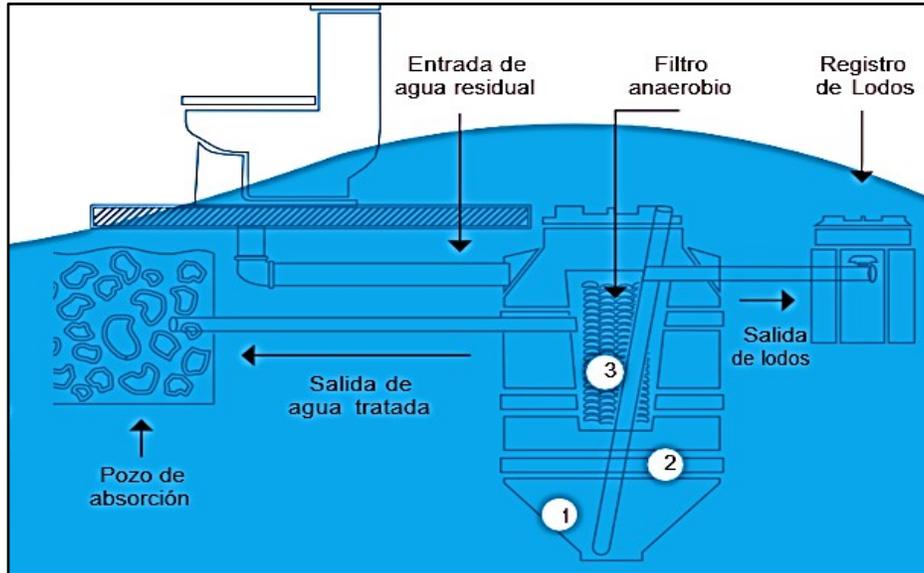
Características de la Planta de Tratamiento.
